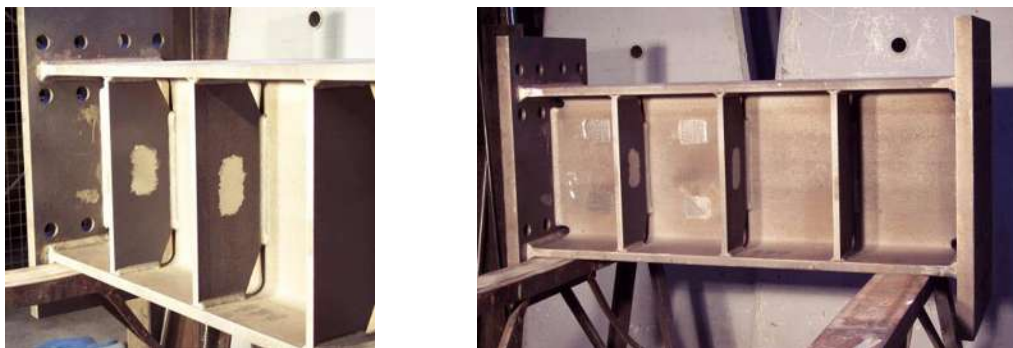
Eslabón reemplazable de sección I con placas terminal. (Mansour; 2010)
